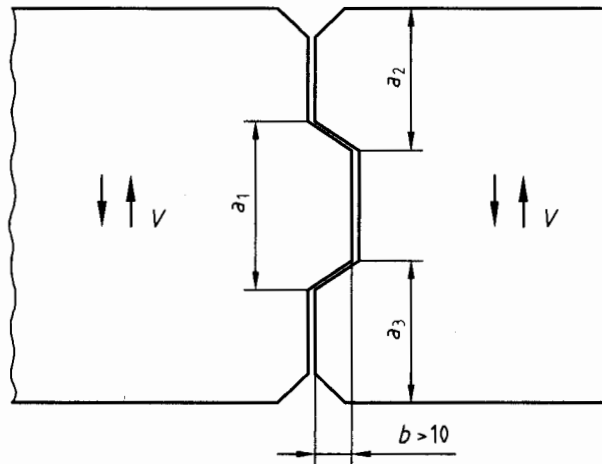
Beispiel für eine trockene Fuge mit Nut und Feder
